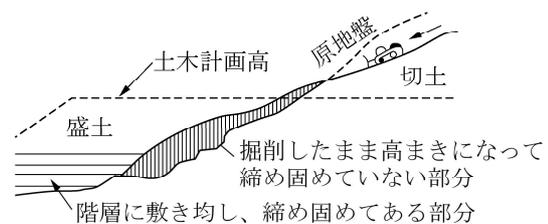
切土・盛土の接続部にありがちな施工状態
